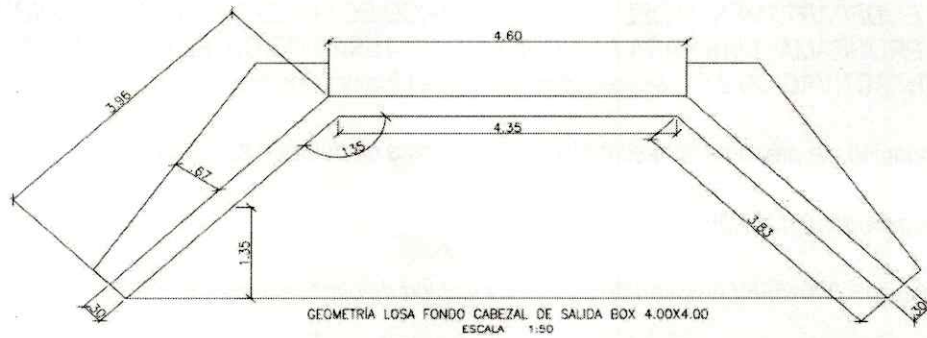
Geometría Losa fondo de cabeza de salida Box Culvert 4m X 4m
